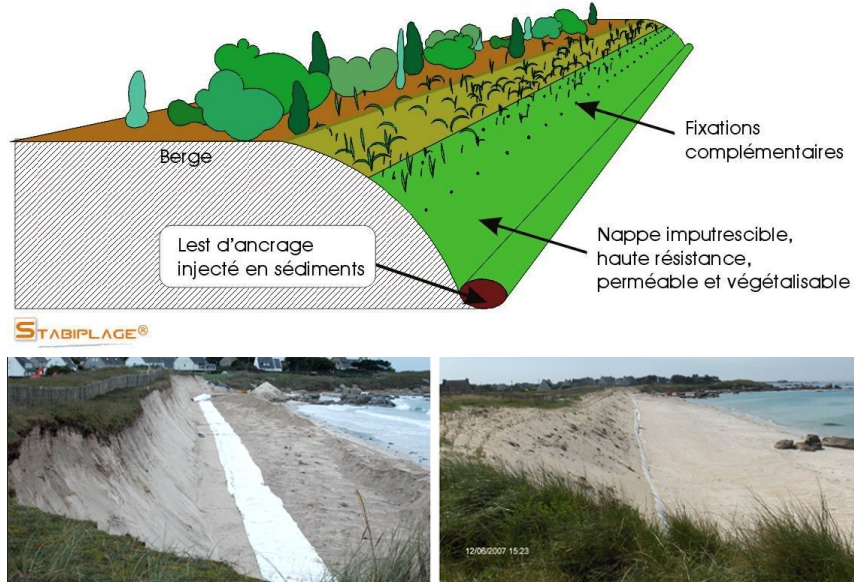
Reprofilage d'une falaise dunaire avec stabiilage®, source: (Haut) Stabiilage.com consulté en 2016, (Bas) Suarez et Cariolet 2007
